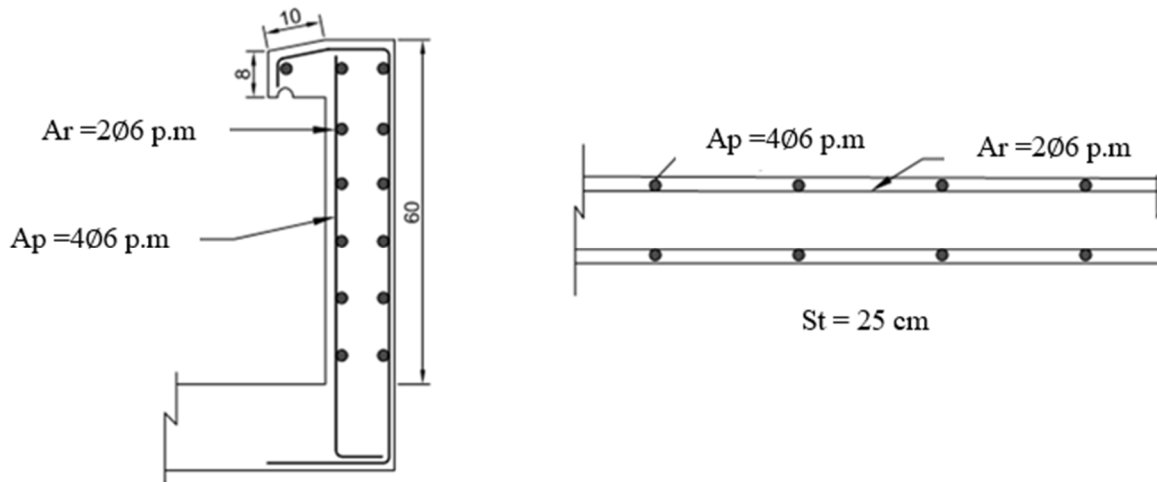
Disposition du ferrailage de l'acrotère.
